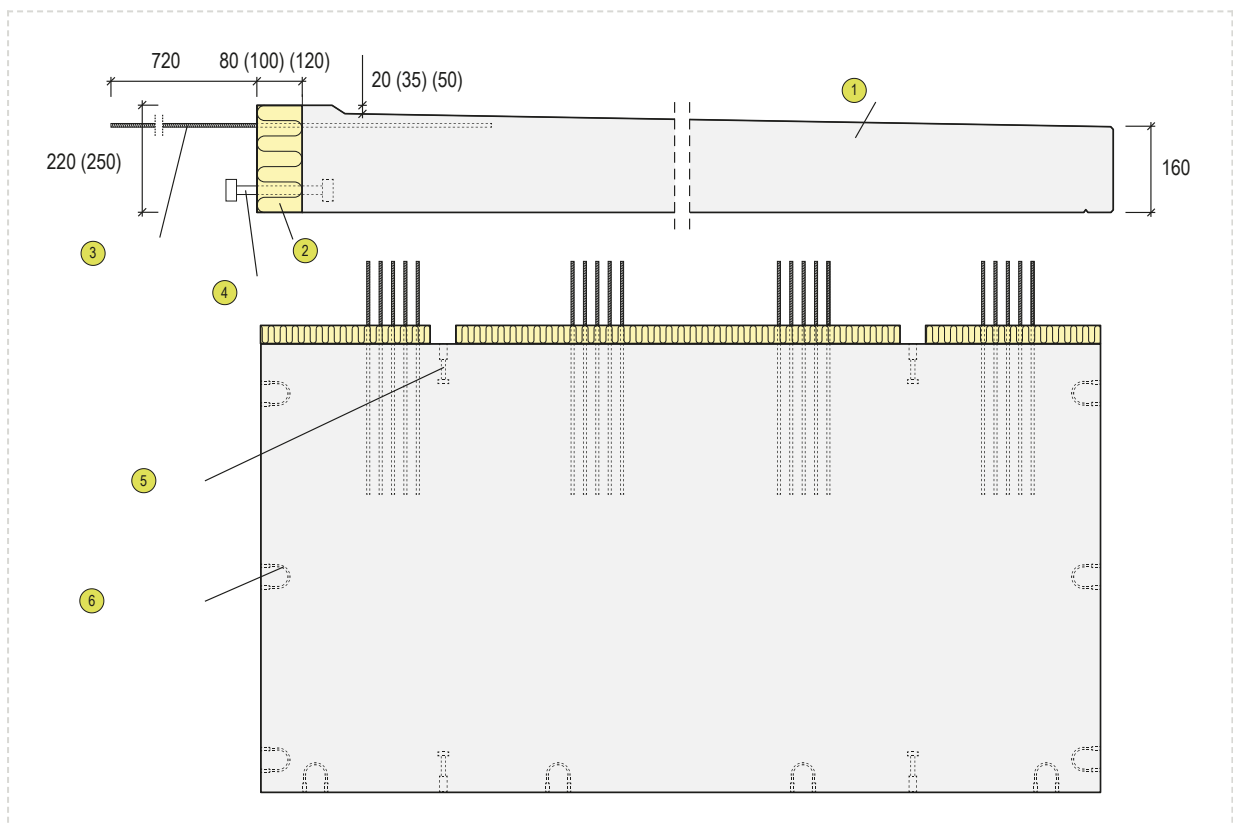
Technisches Detail des Balkonknotens: Prinzipdarstellung; die tatsächliche Ausführung nach Tragwerksprojekt.
